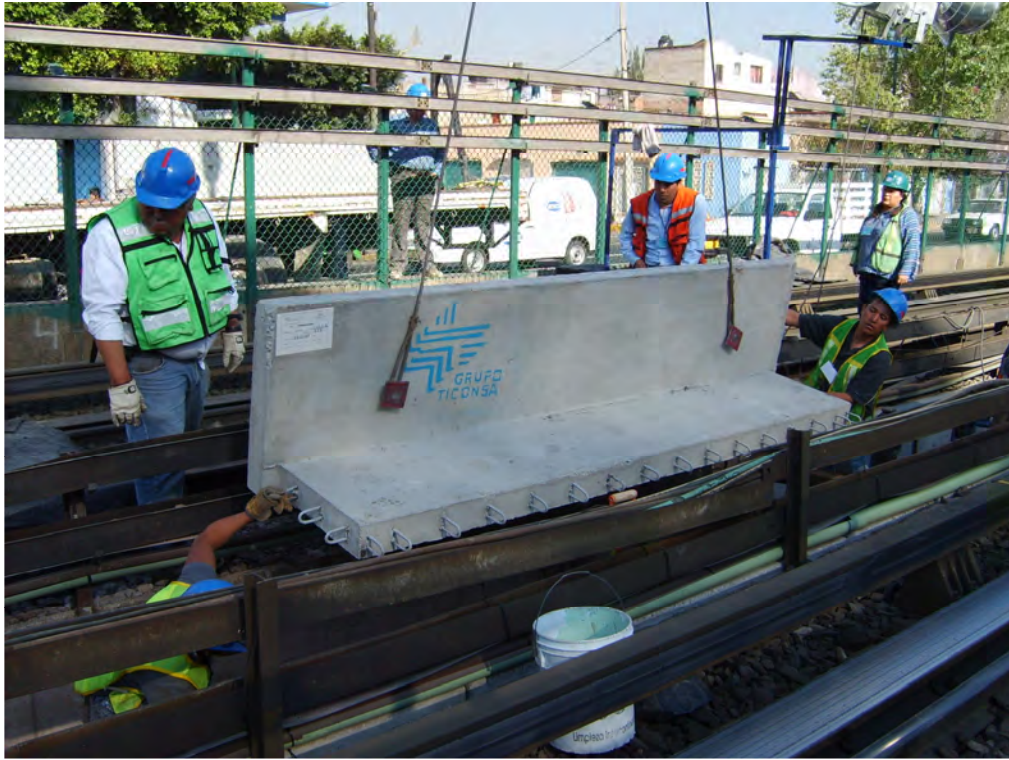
Colocación de prefabricados con grúas de 10 toneladas.
